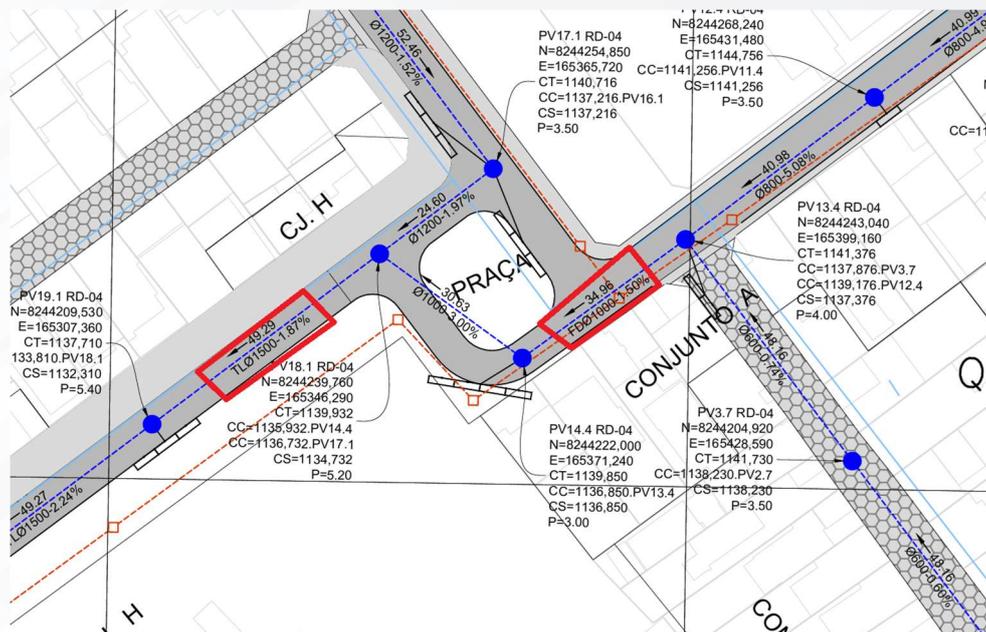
Planta de Drenagem da A Rossetto demonstrando a utilização de Furo Direcional e Tunnel Linner.
